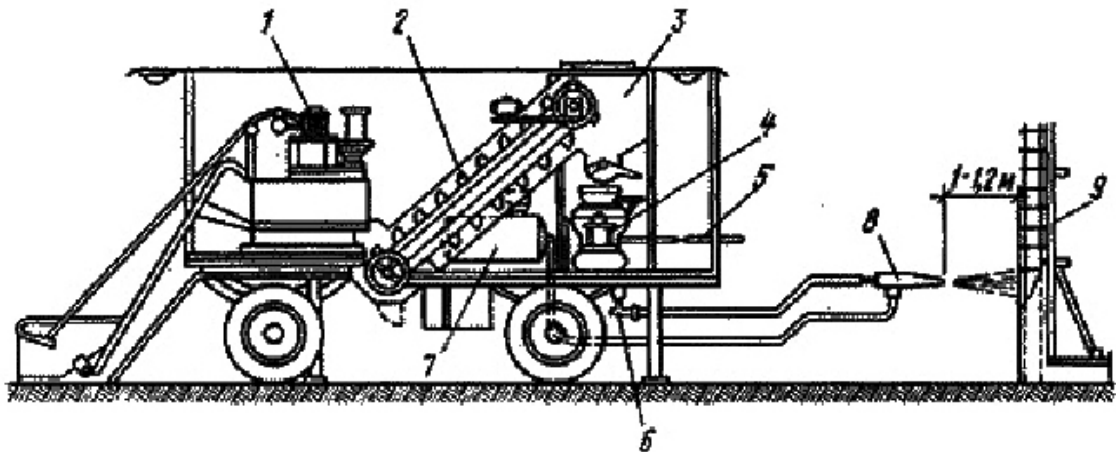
Бетонування методом «набризк-бетон»:
